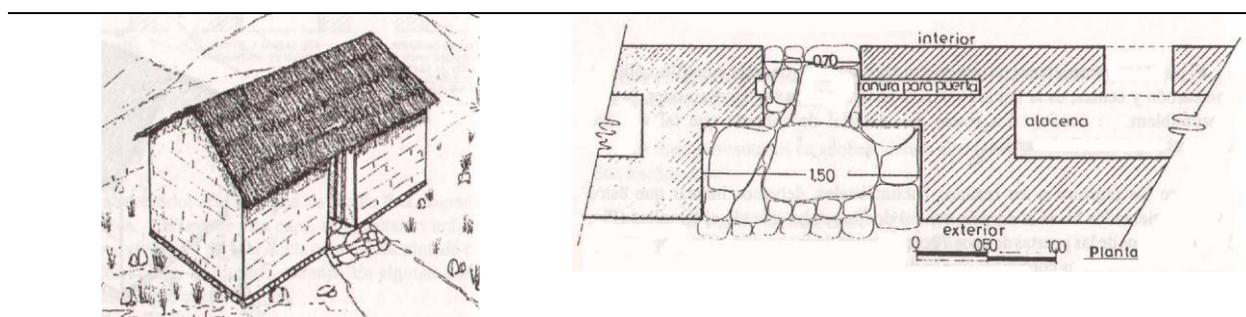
Reconstrução da cobertura e o detalhe do ingresso pavimentado
